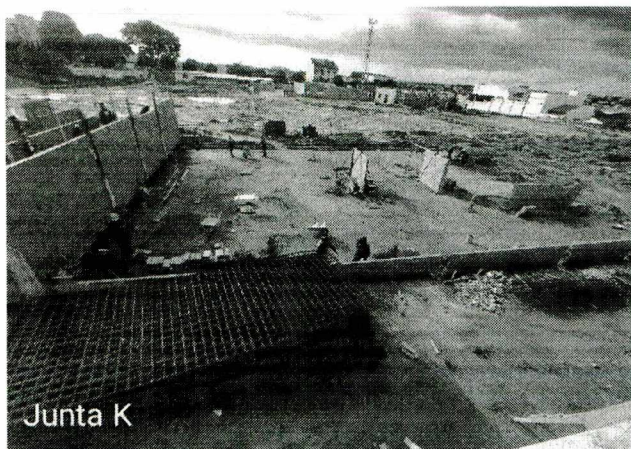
a 40: concretagem de baldrames; execução de alvenaria de primeira e segunda etapa; concretagem de pilares.
